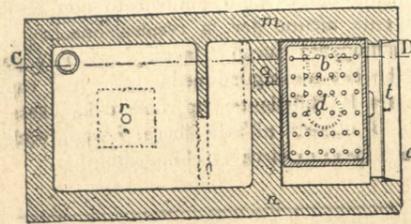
Sezione orizzontale dell'apparecchio Chopard.
